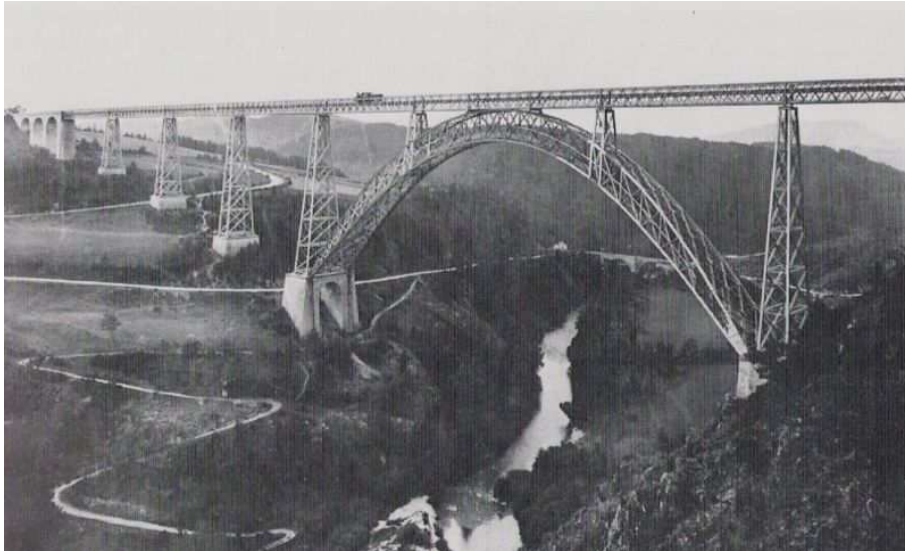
Viadotto di Garabit - foto raffigurante lo stato attuale
